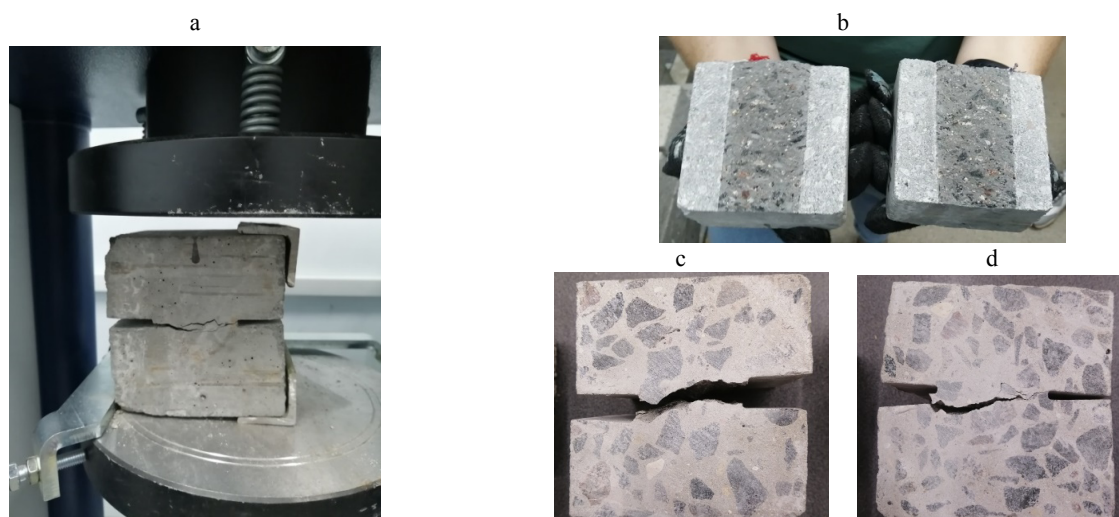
Испытание на нормальный отрыв по кубам с надрезом: а – внешний вид испытания; б – половинки образца после испытаний; с – испытанный бетонный образец; д – испытанный нанофибробетонный образец
